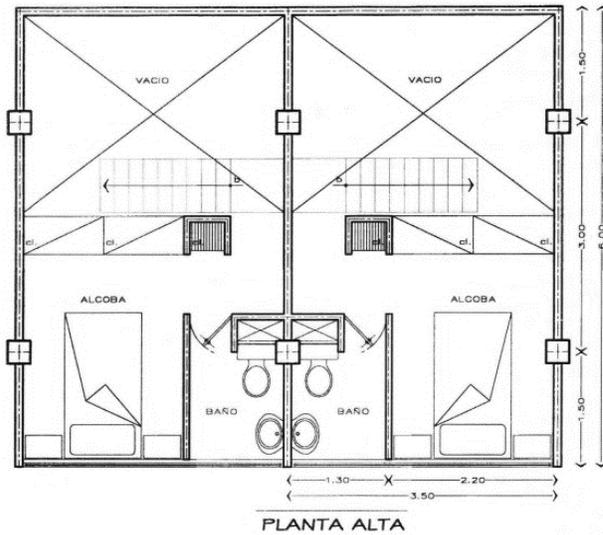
Proyecto de la ciudad obrera de México (Planta Tipo).
